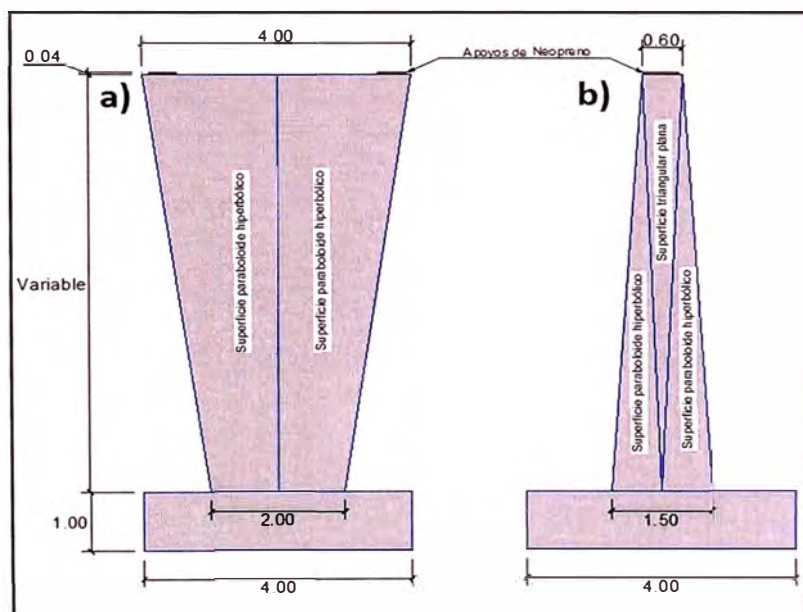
a) Corte A - A y b) Corte B - B de la vista en planta.
